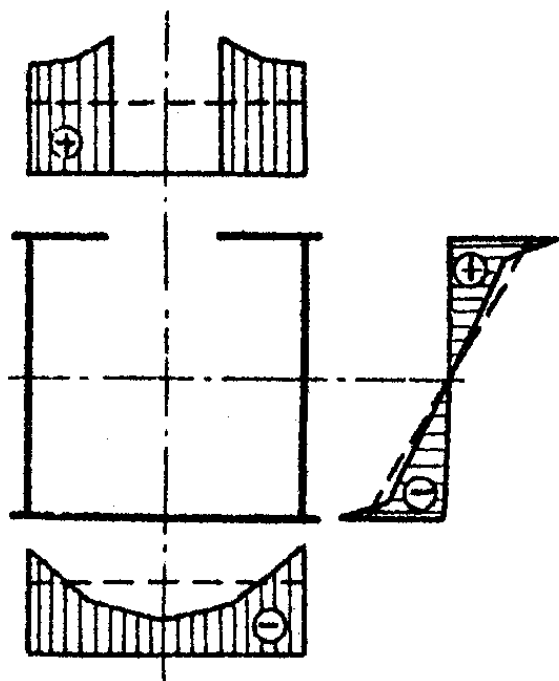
Эпюры напряжений в сечении коробчатой балки
